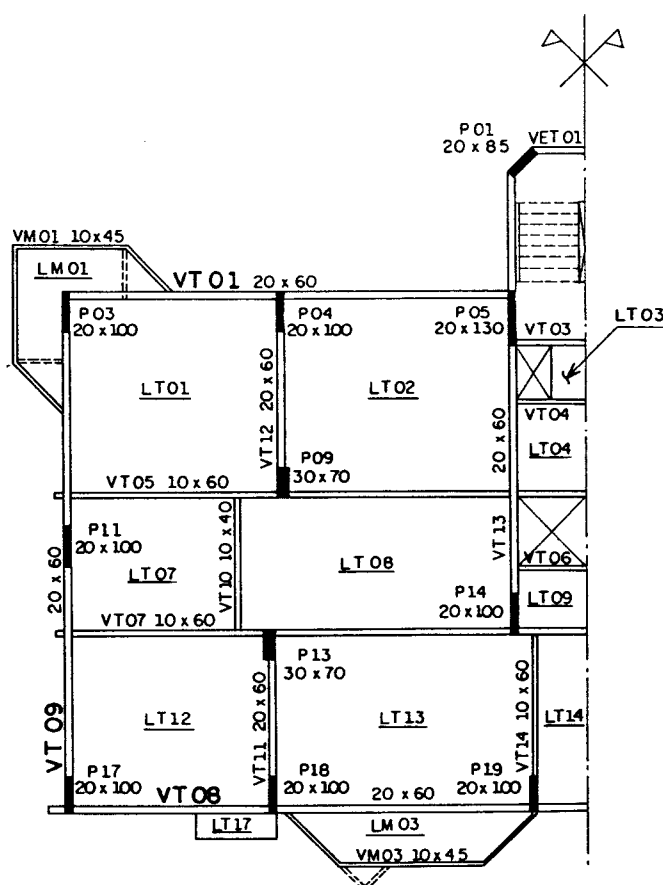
Localização das vigas VT01, VT08 e VT09 no pavimento-tipo
